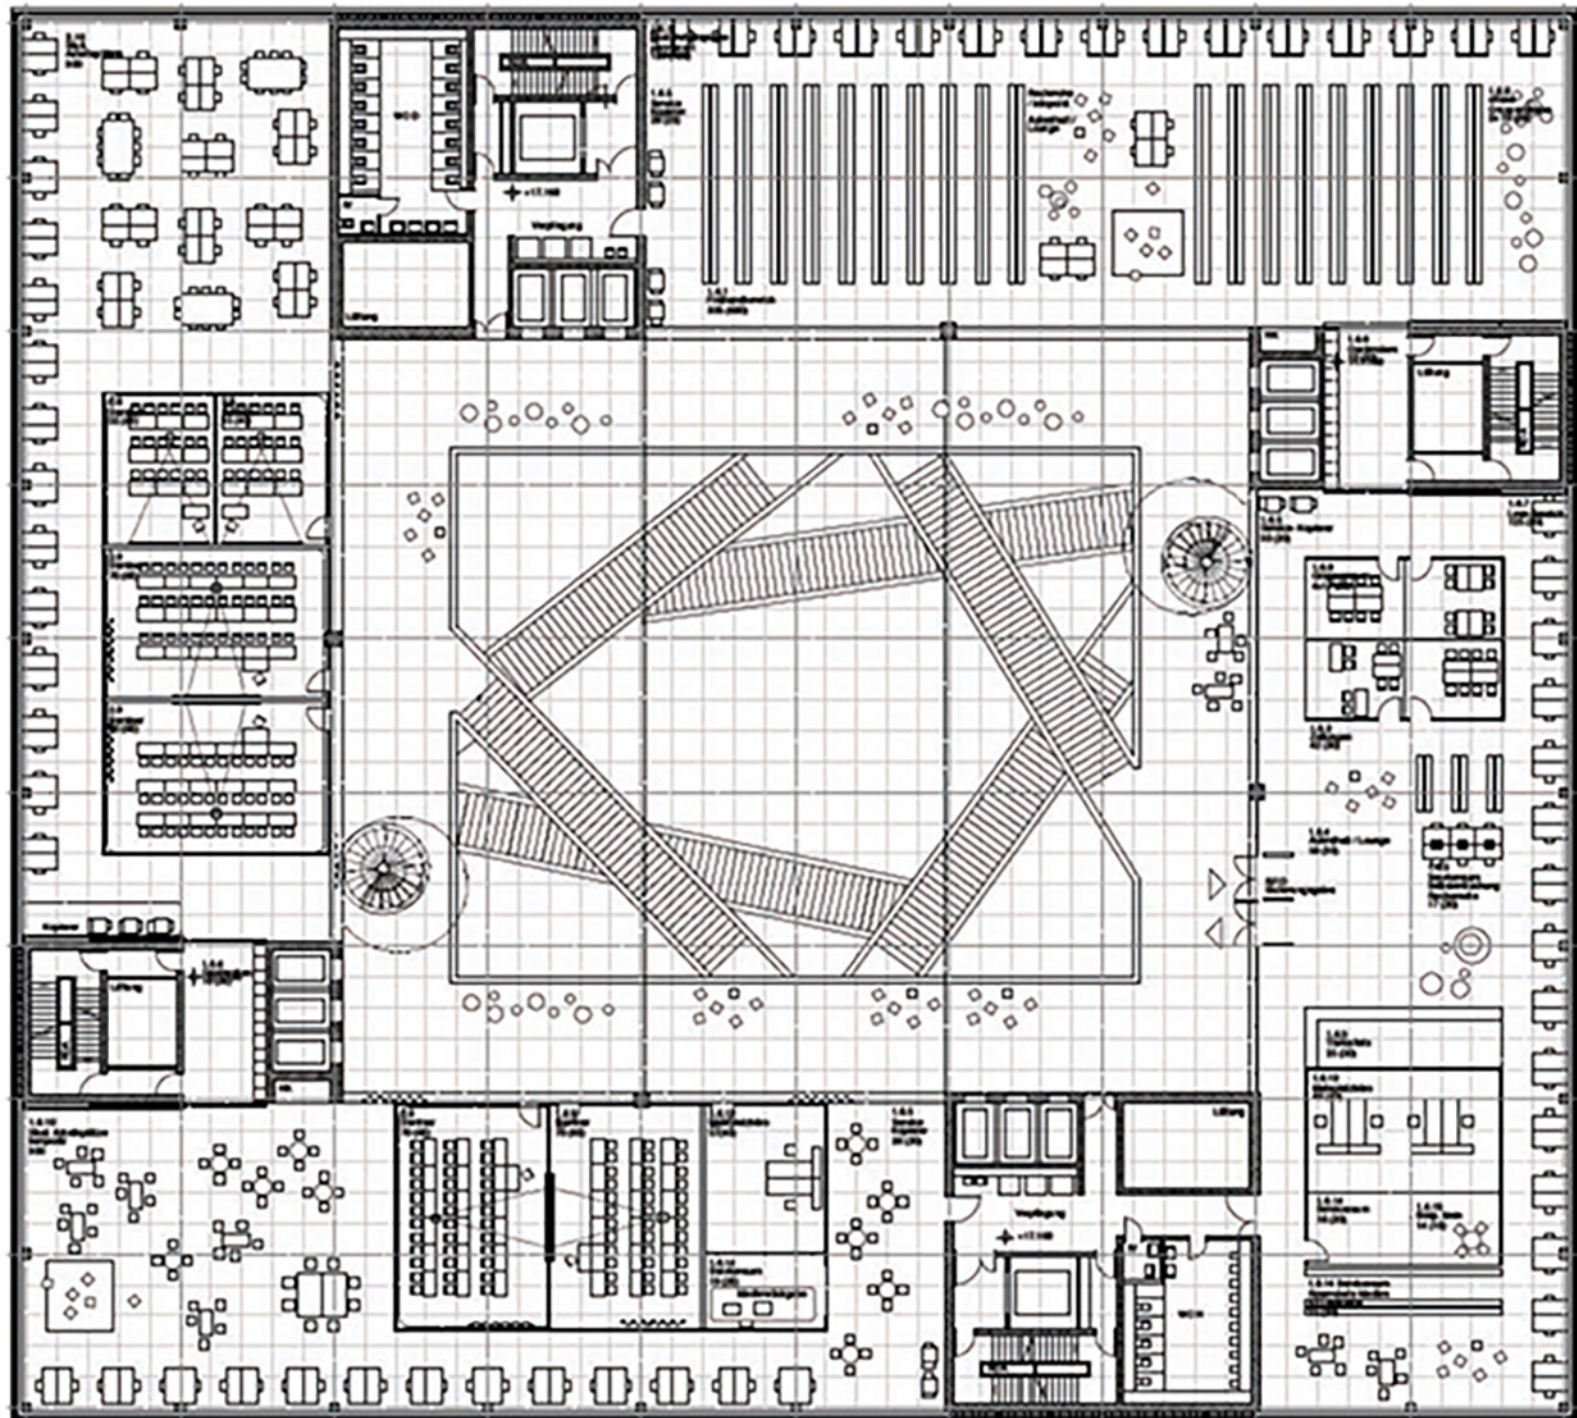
Grundriss Bibliotheksgeschoss (Plan pool Architekten AG)
